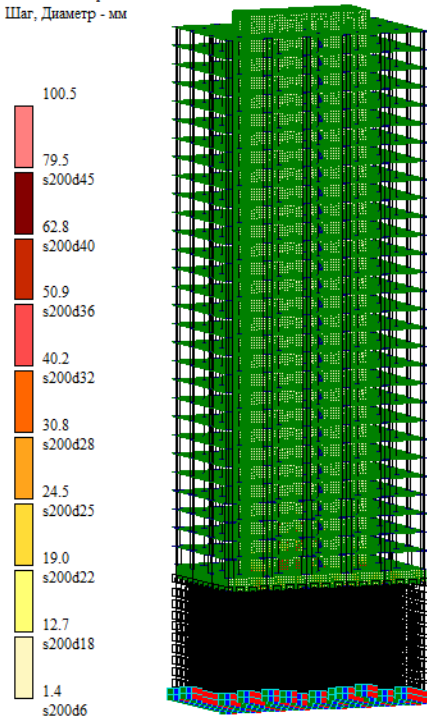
Схема армирования наружной части стен по оси OX, OY
